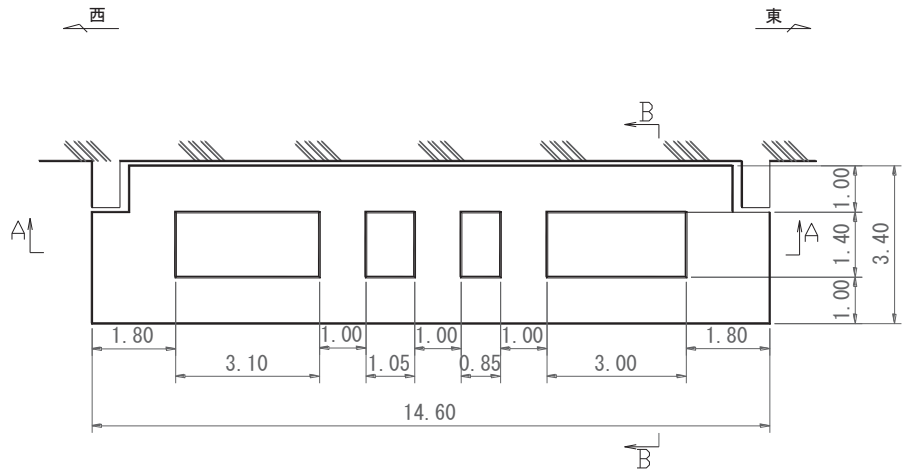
第 3 号機補機冷却海水系放水ピット平面図 (D-D 断面)
